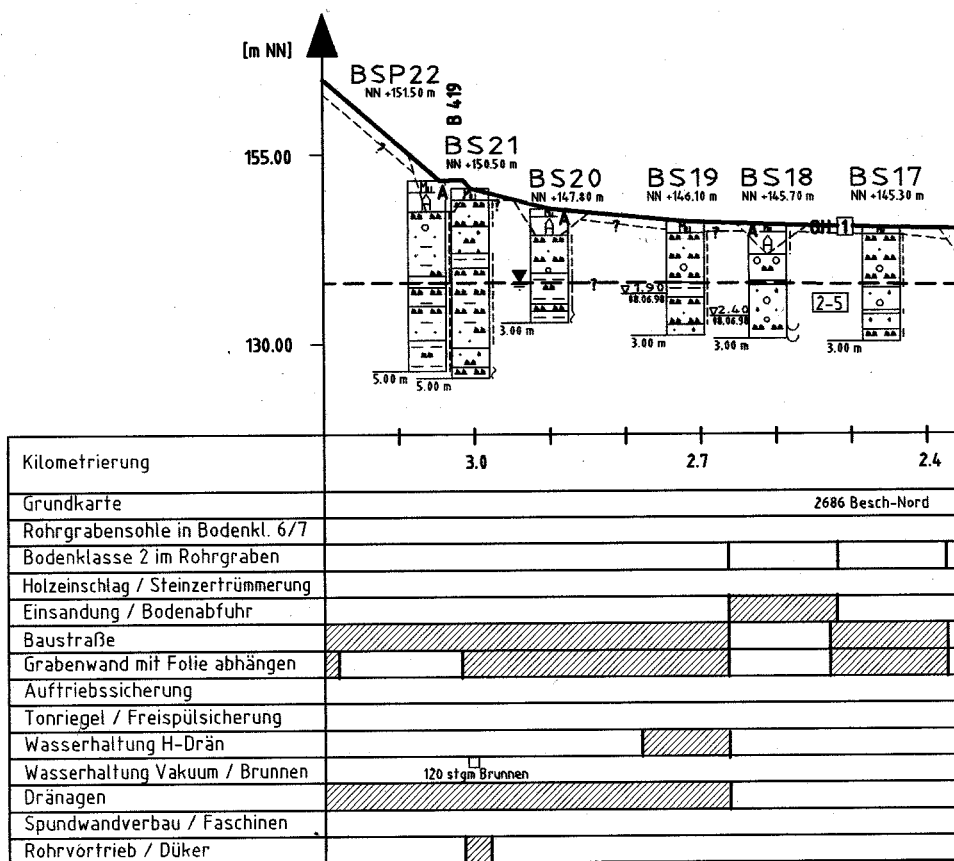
Ausschnitt aus dem Geotechnischen Längsschnitt (DR. SPANG GMBH, 1998)
